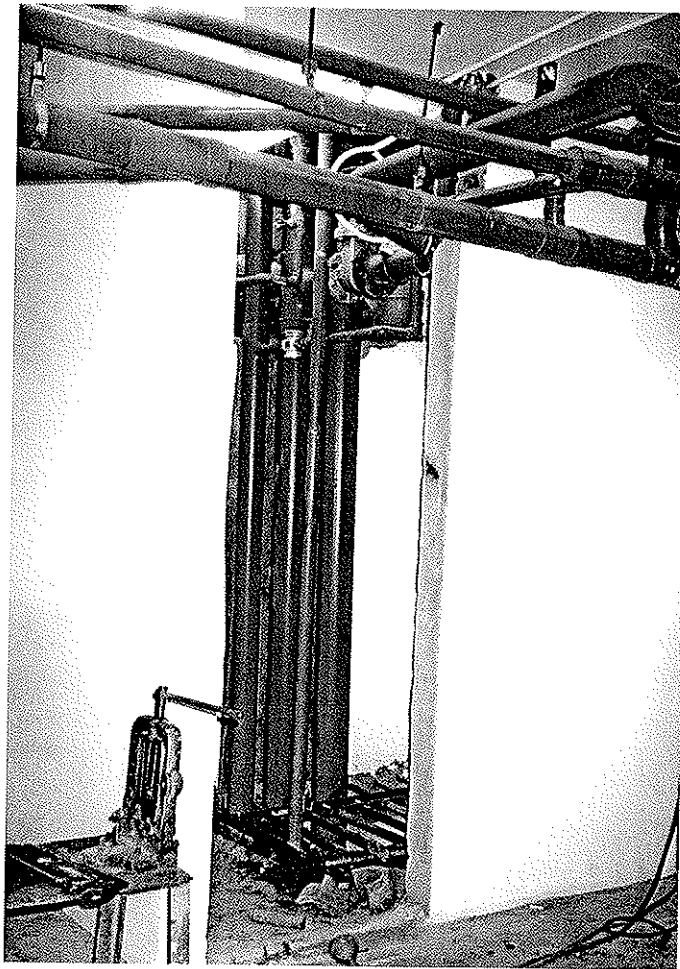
Pipa Hidrant dan Pipa Sprinkler
